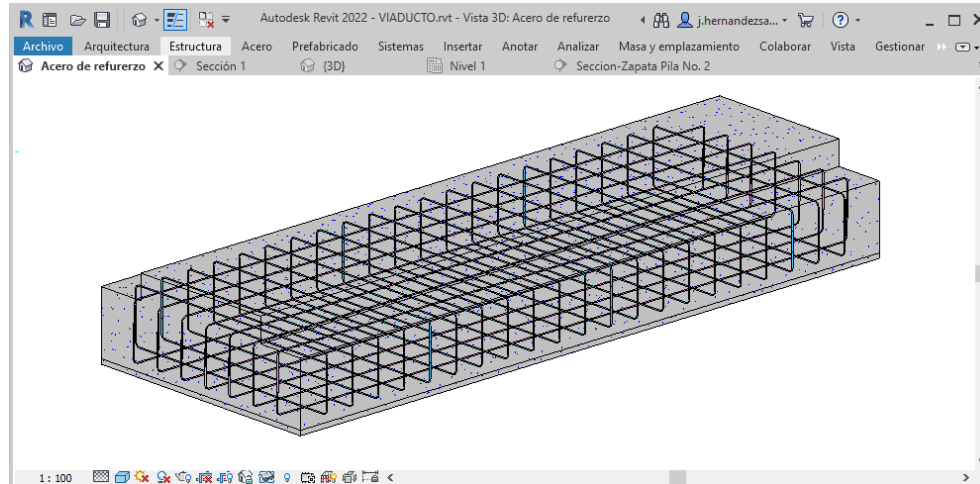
Configuración de barras de refuerzo en zapata. Fuente: Elaboración propia
